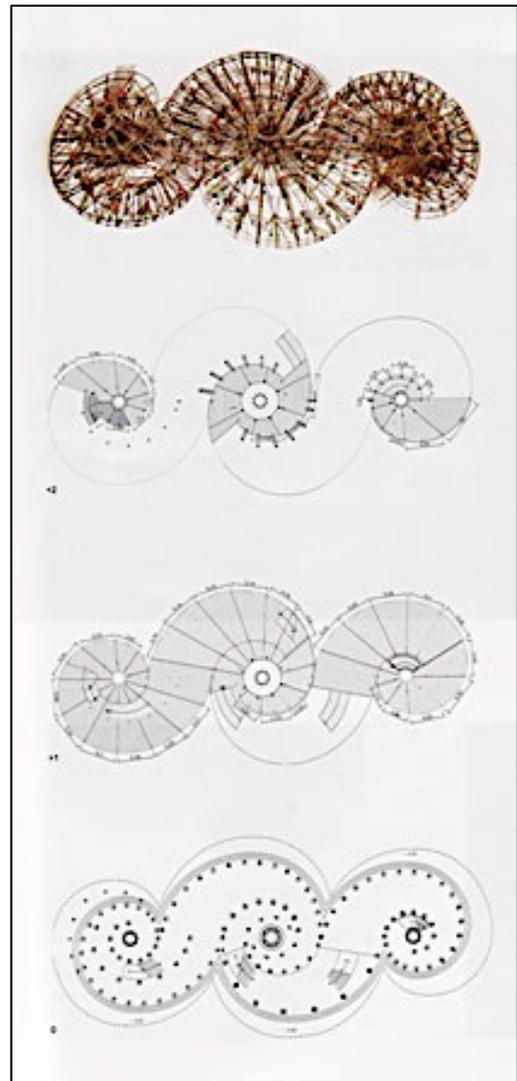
Planta de la Green School. Fuente: Arquitectura Viva, “Bucles de bambú...”, p. 51.
